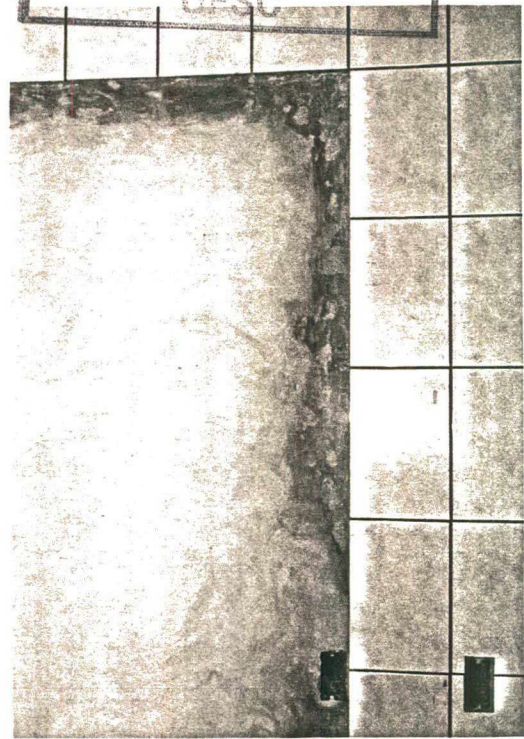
E Eliminação de parede colocando à mostra uma viga de concreto armado.
